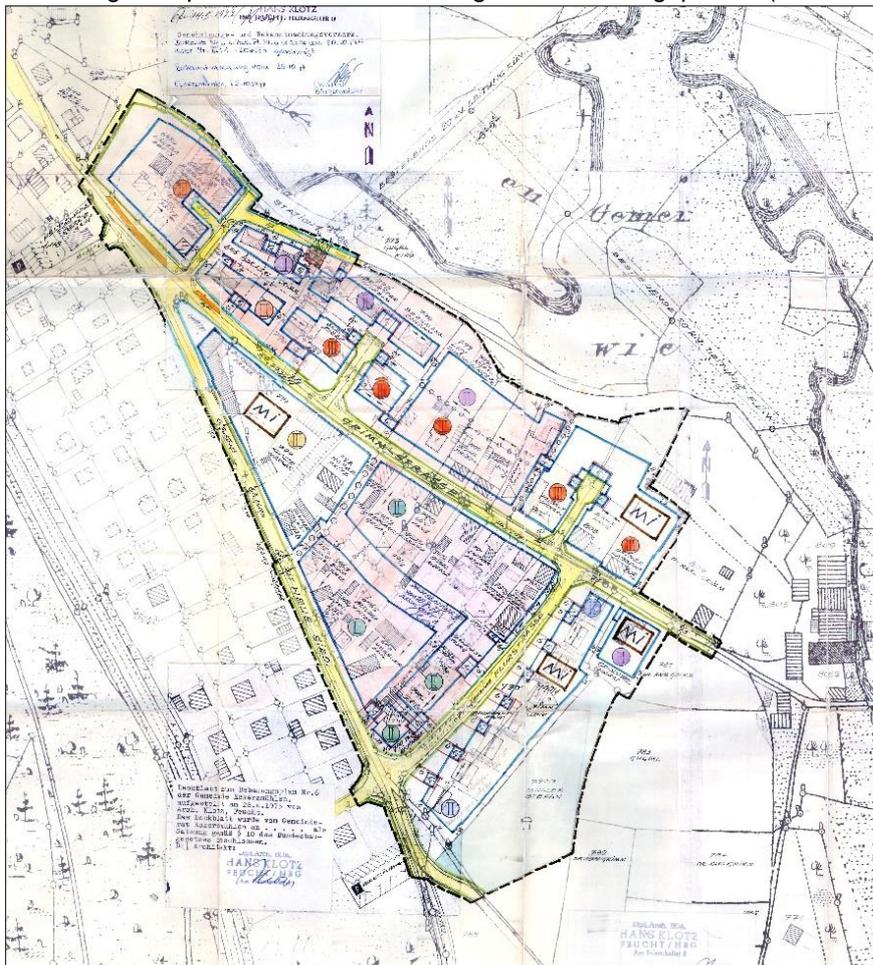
Urplan mit 2. + 3. Änderung des Bebauungsplanes (im Planblatt eingeklebt)
